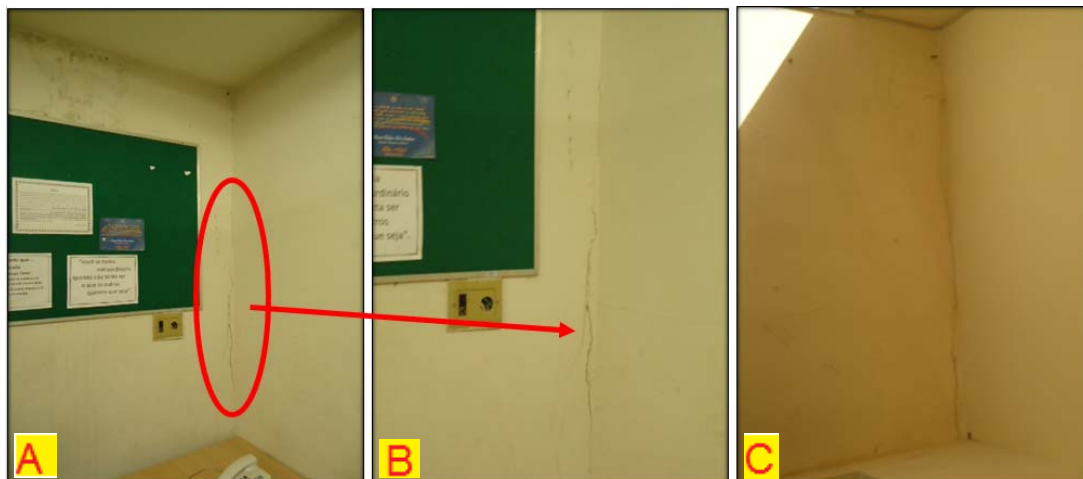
Fissuras causadas por falta de amarração entre as paredes
